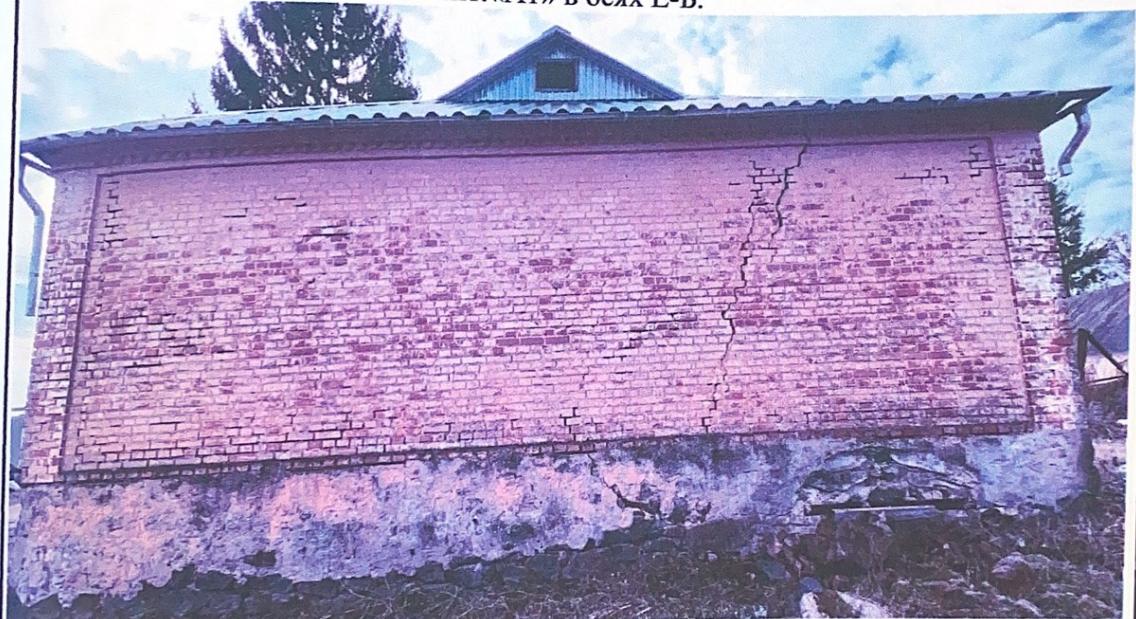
Фасад прибудови літ.«А1» в осіх 8-6.
